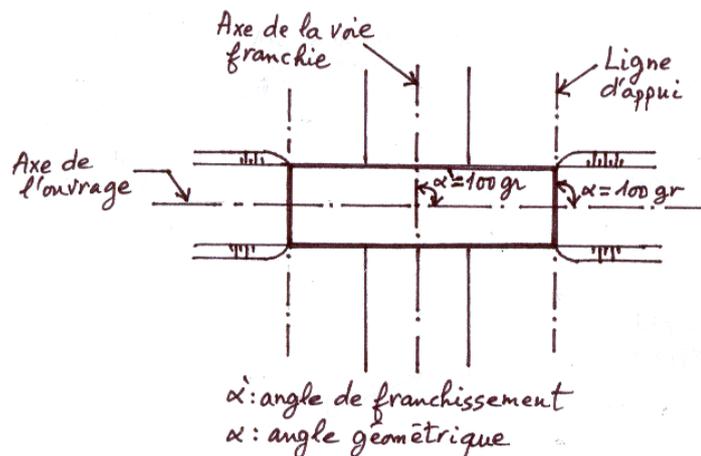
Vue en plan d'un pont droit en géométrie et en franchissement.
